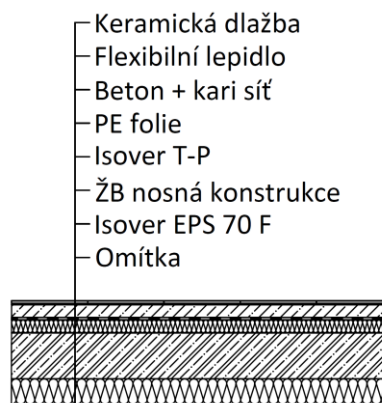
Skladba vyšších podlaží stropní konstrukce
